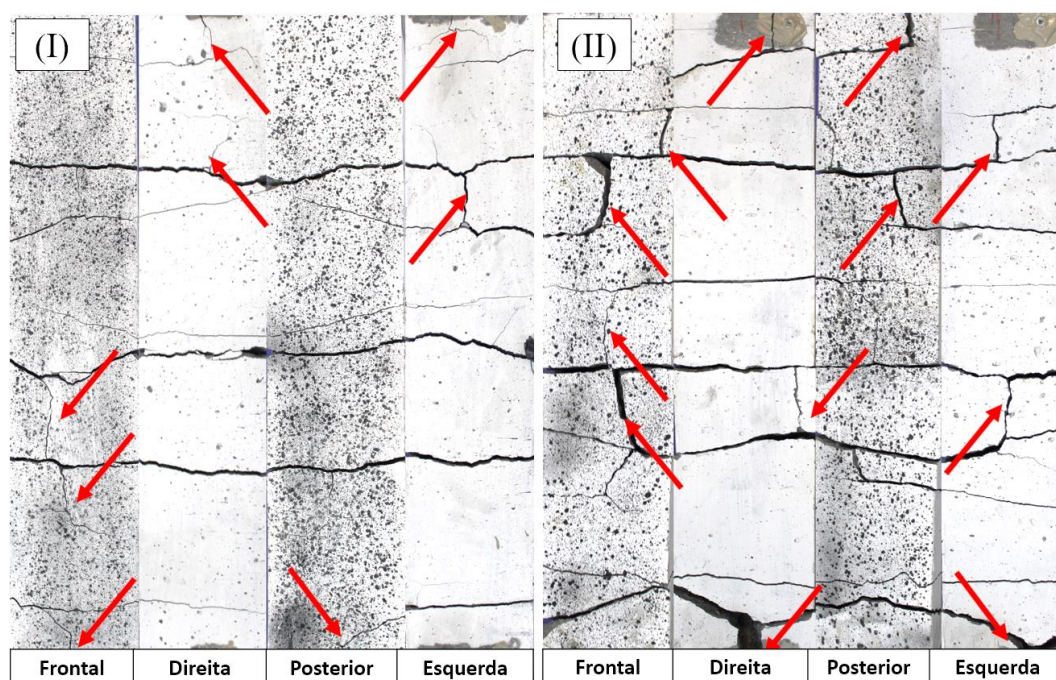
Mapas de fissuras do grupo C1.H.25.
